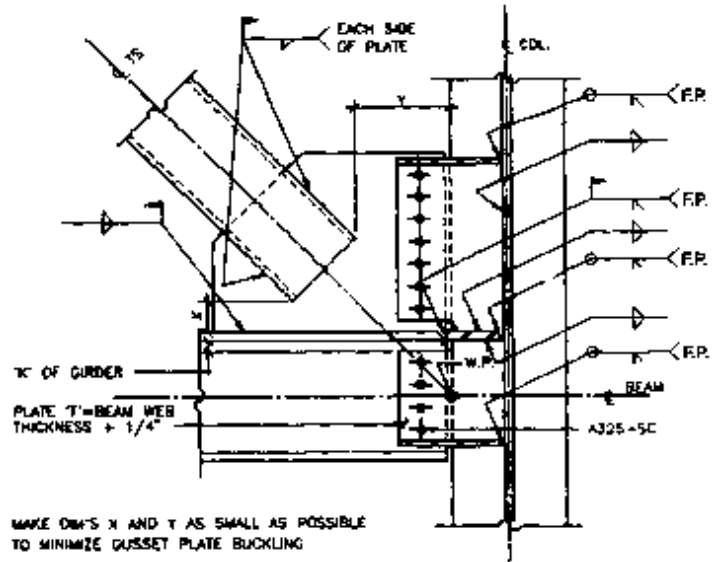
Conexión contraviento a columnas y viga con placa atornillada (Becker, Ishler; 1996)
